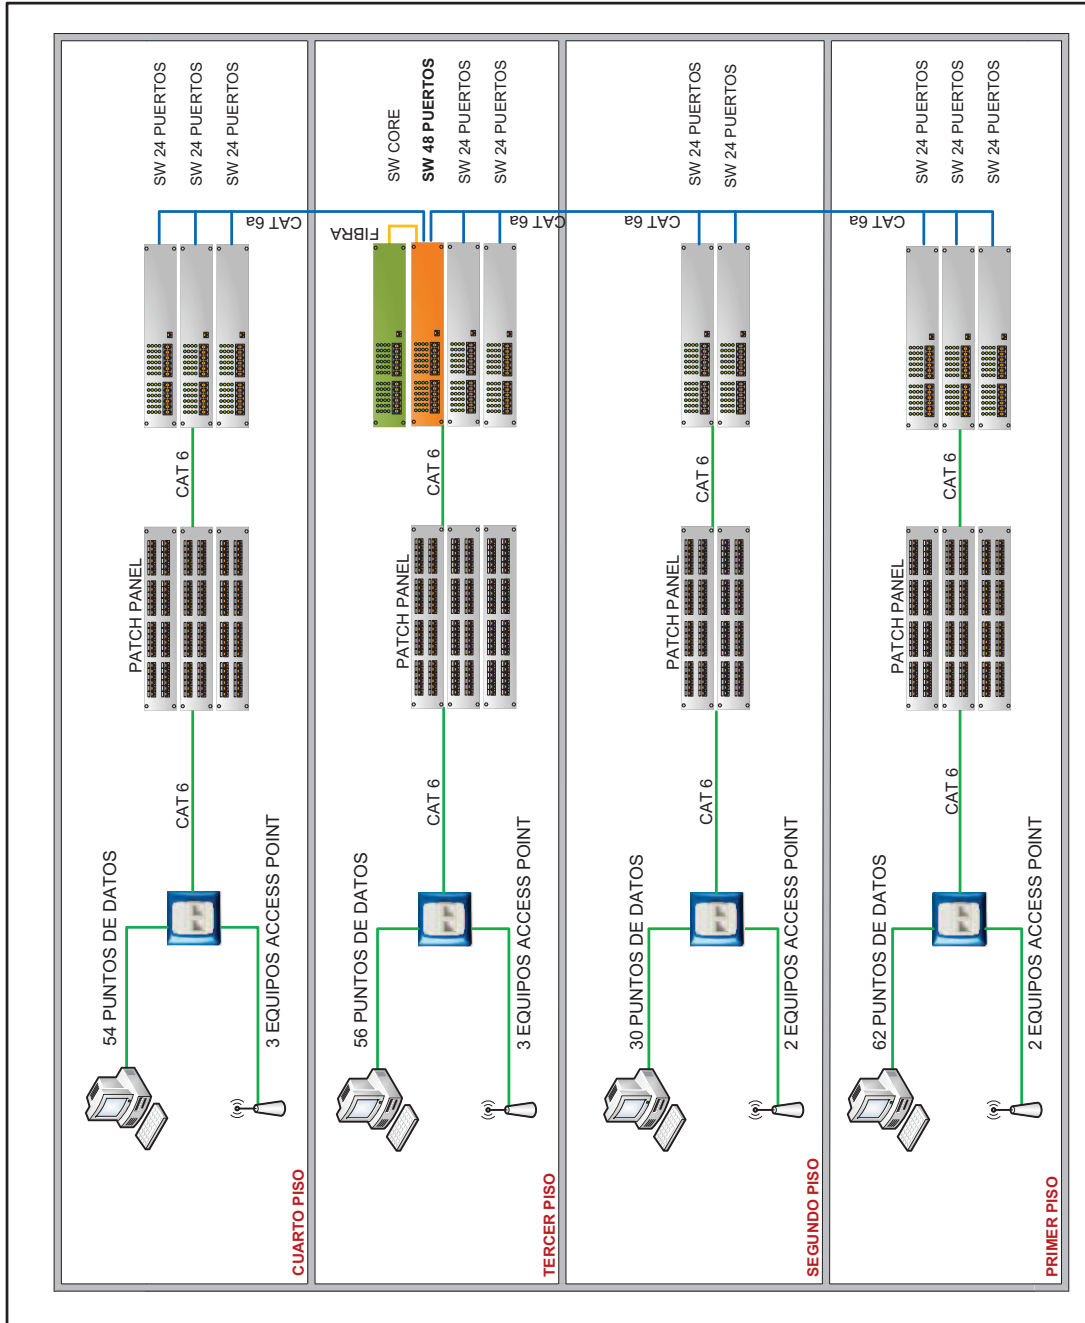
Cableado horizontal y vertical en el edificio Internado
